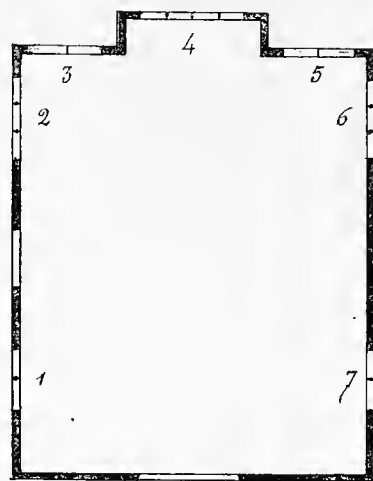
Plan de la chapelle Notre-Dame du Cran, à Spezet.
